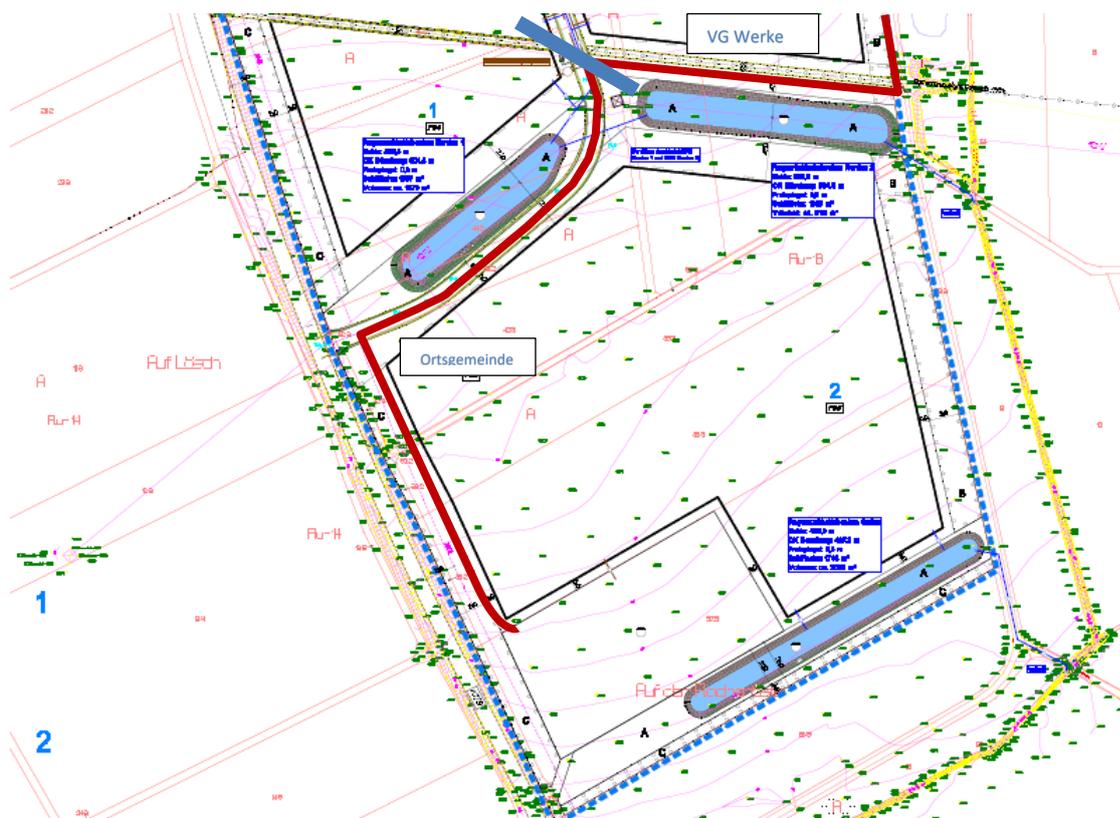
Ausschnitt Lageplan - Verlauf SW-Kana
